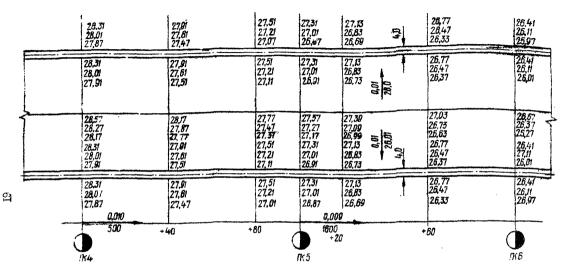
План вертикальной планировки грунтового основения искусственных покрытий МС на стадии рабочих чертежей
